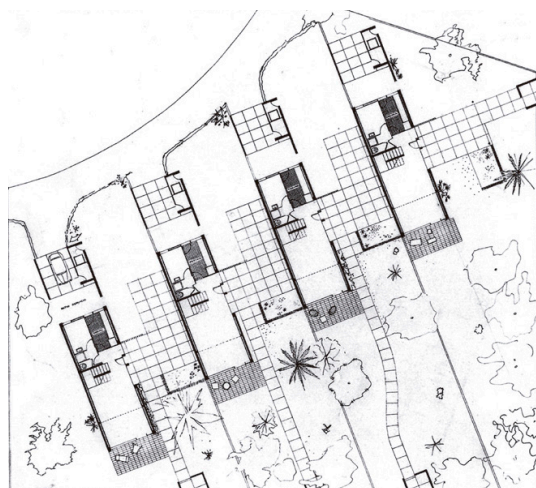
Planta conjunt d'habitatges Torredembarra, Josep Maria Sostres.
